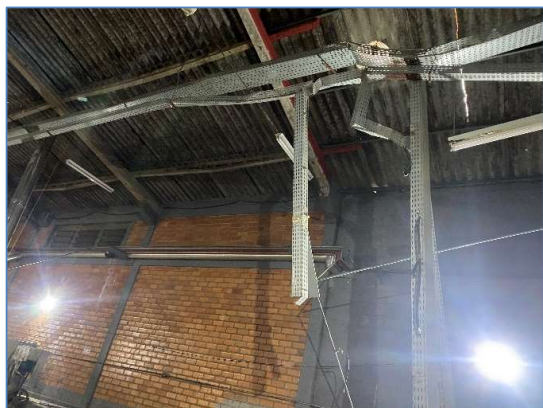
vista interna do galpão/barracão, mau estado de conservação, telhas trincadas, infiltrações.
